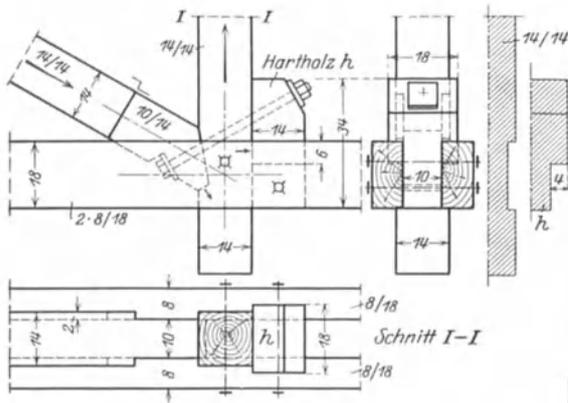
Knotenpunkt eines Fachwerkbinders ohne patentrechtlich geschützte Dübel¹⁾. Untergurtzangen sind in den Zugpfosten eingelassen. Druckdiagonale mit Versatz und Bolzenanschluß. Für Aufnahme des Horizontalschubes der Diagonale zeigt das Hartholzstück *h* eine Druckfläche von $2(6,0 \cdot 4,0) = 48 \text{ cm}^2$.
